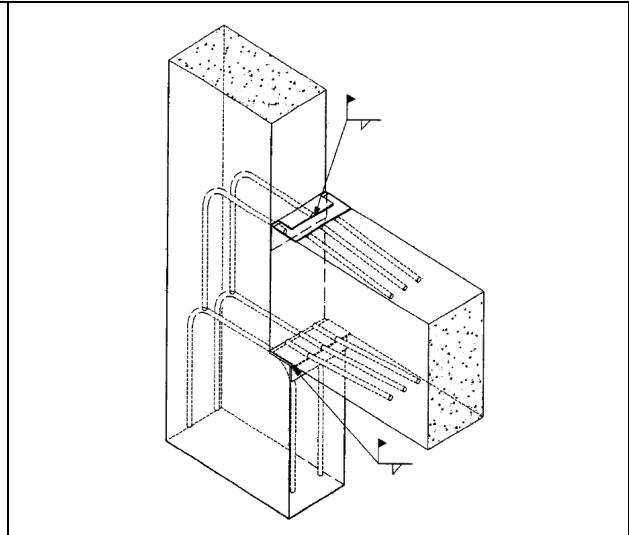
Ligação por consola curta de betão e armadura (PCI, 1999)
